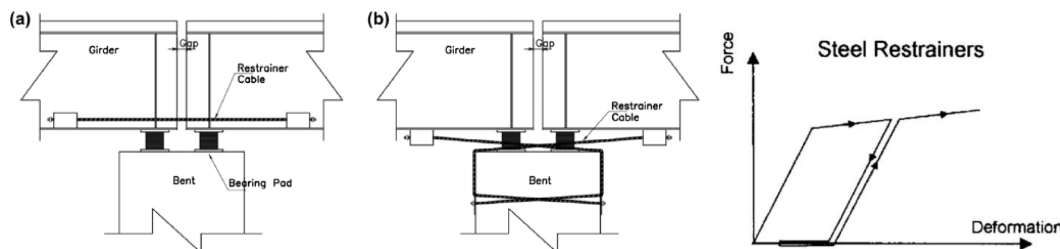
(a) Cable Viga a Viga; (b) Cable Viga a Columna; Comportamiento Fuerza – Deformación de los cables [28]
